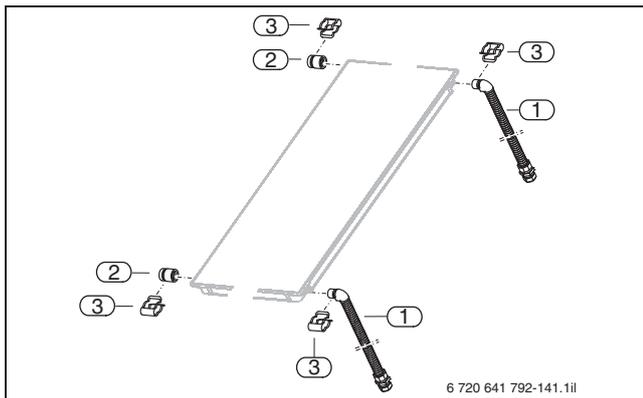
Set di collegamento Logasol SKS4.0 sopra tetto/integrazione nel tetto
